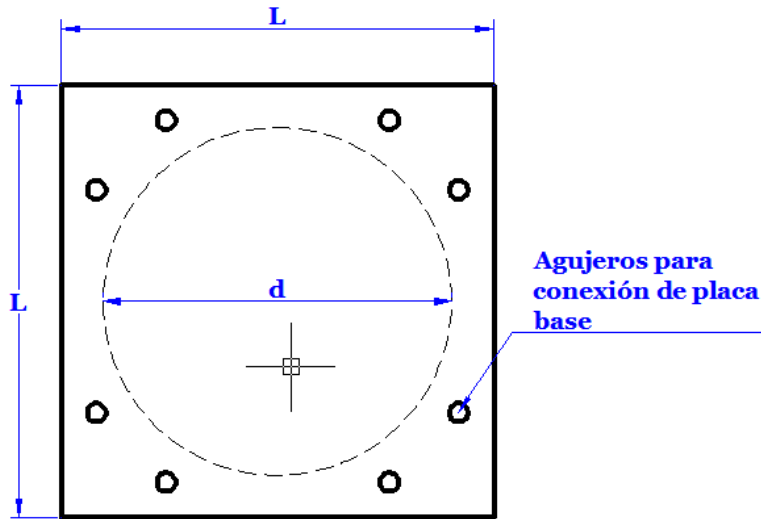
Dimensiones y elementos de un aislador elastomérico laminado (Planta)
